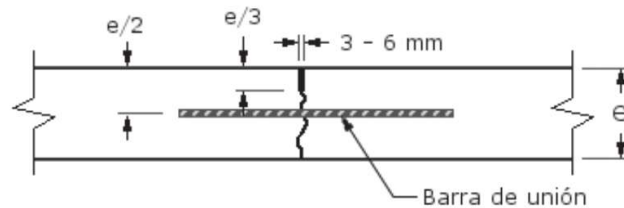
JUNTA TIPO C-1. JUNTA LONGITUDINAL DE CONTRACCIÓN CON BARRA DE UNIÓN.
